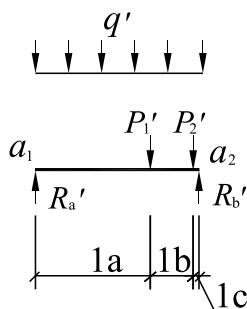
Расчетная схема продольного изгиба элемента f_2 фермы Ф-1
